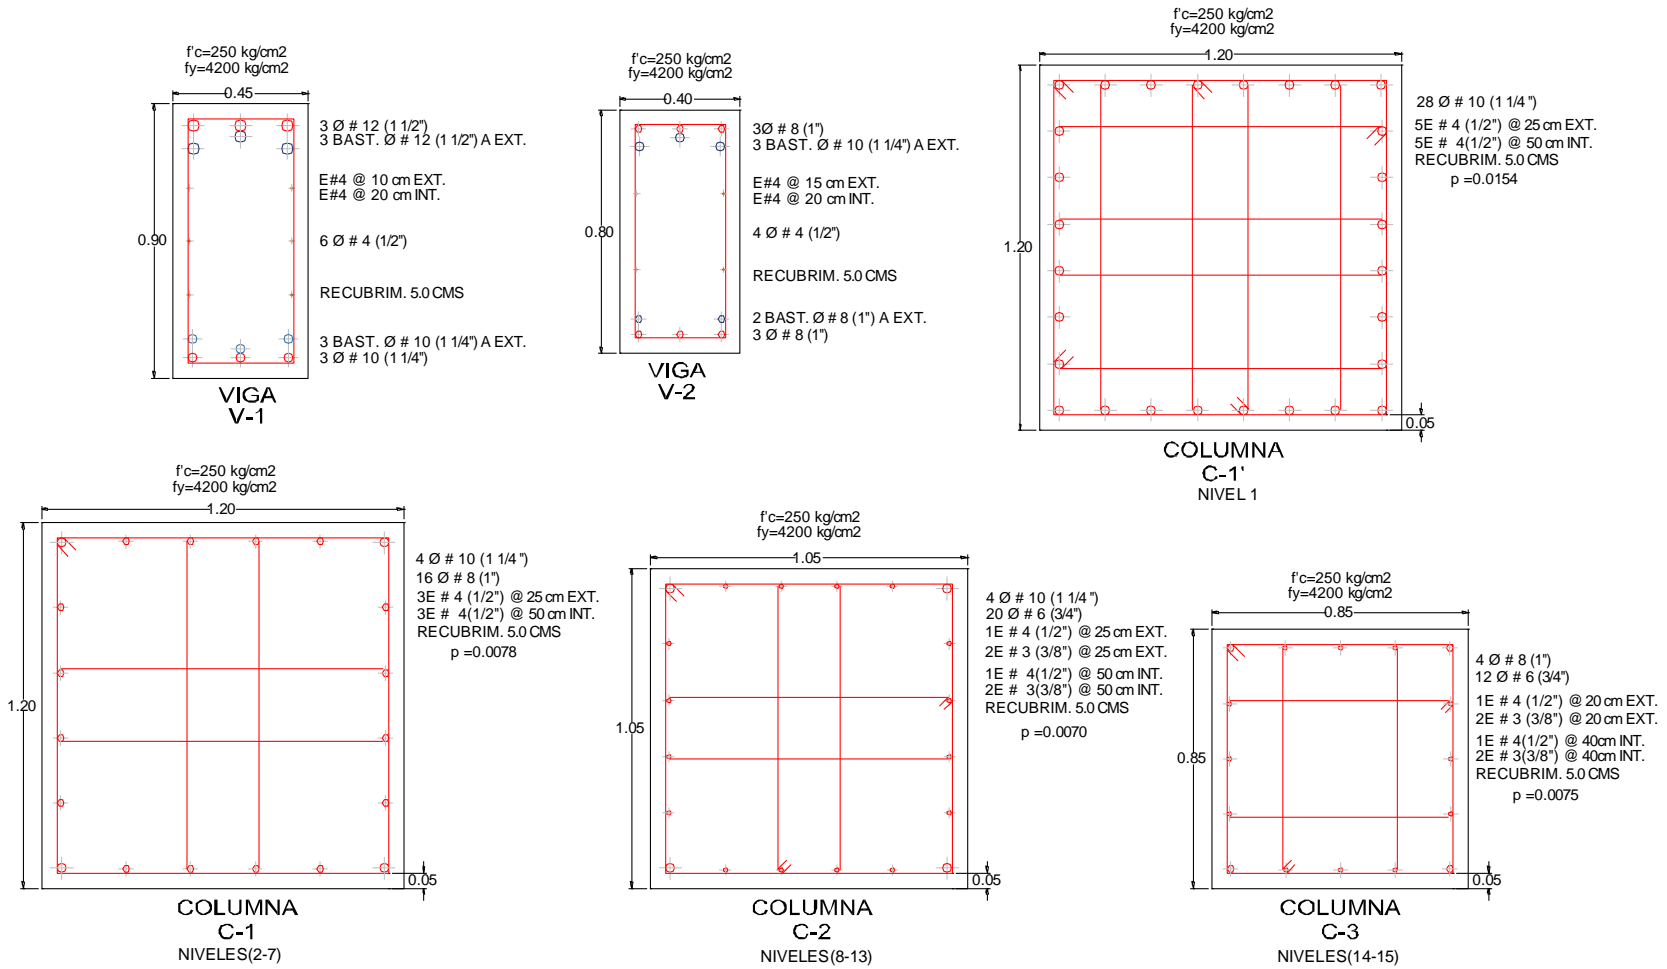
Detallado de armado de vigas y columnas del marco de 15 niveles con base a secciones gruesas.
